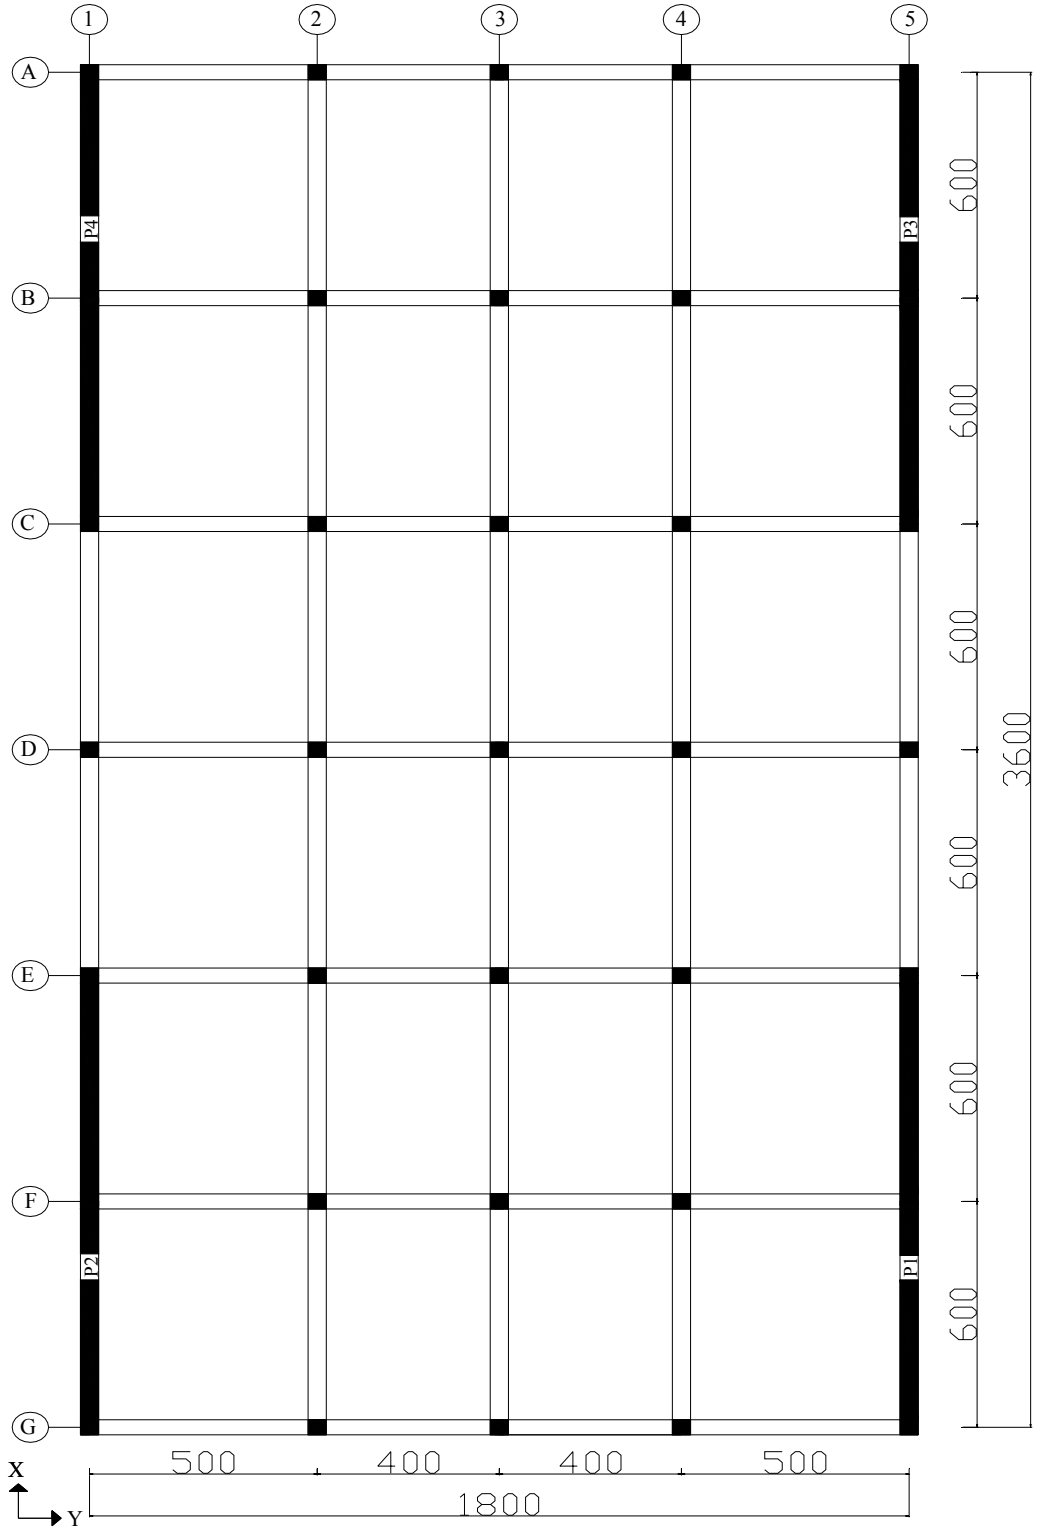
Örnek 5.9'un kat kalıp planı
